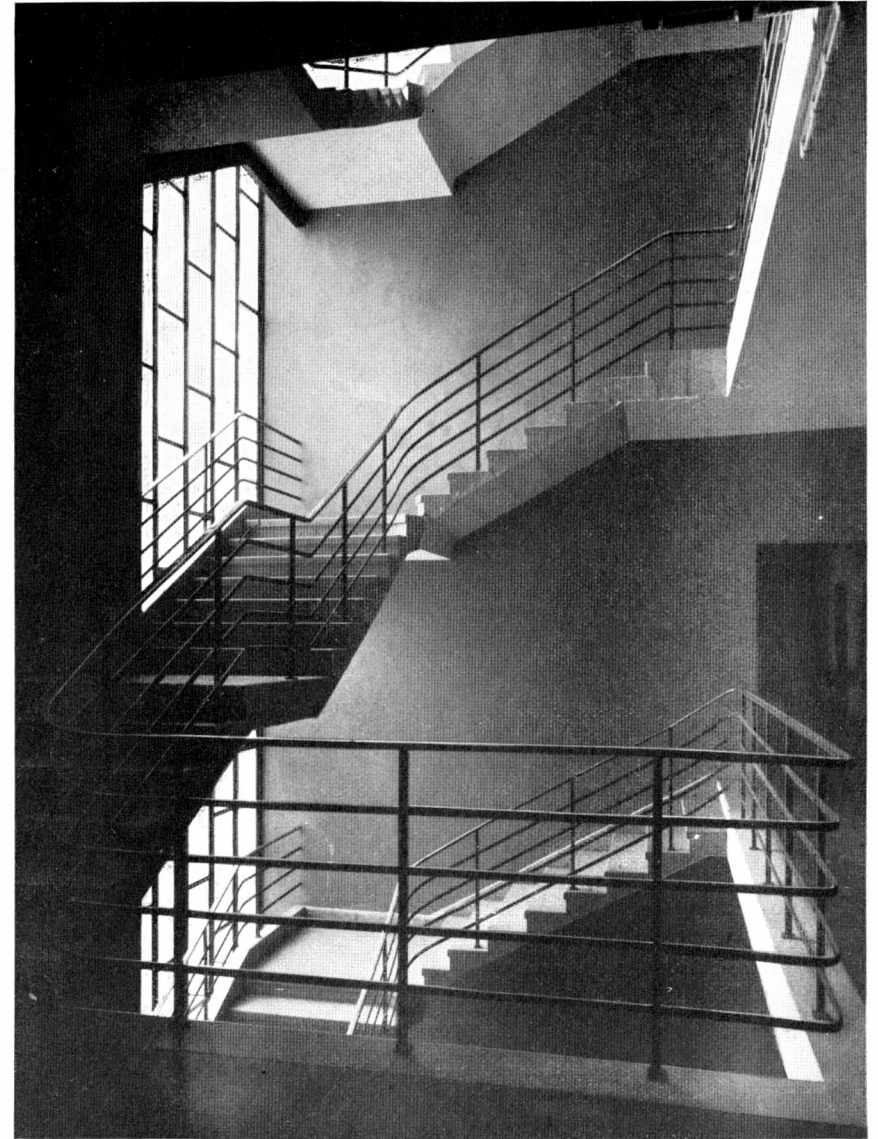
Adolf Meyer, Frankfurt a. M. (Städt. Hochbauamt): Prüfamnt IV der Städtischen Elektrizitätswerke Frankfurt a. M. im Rohbau
